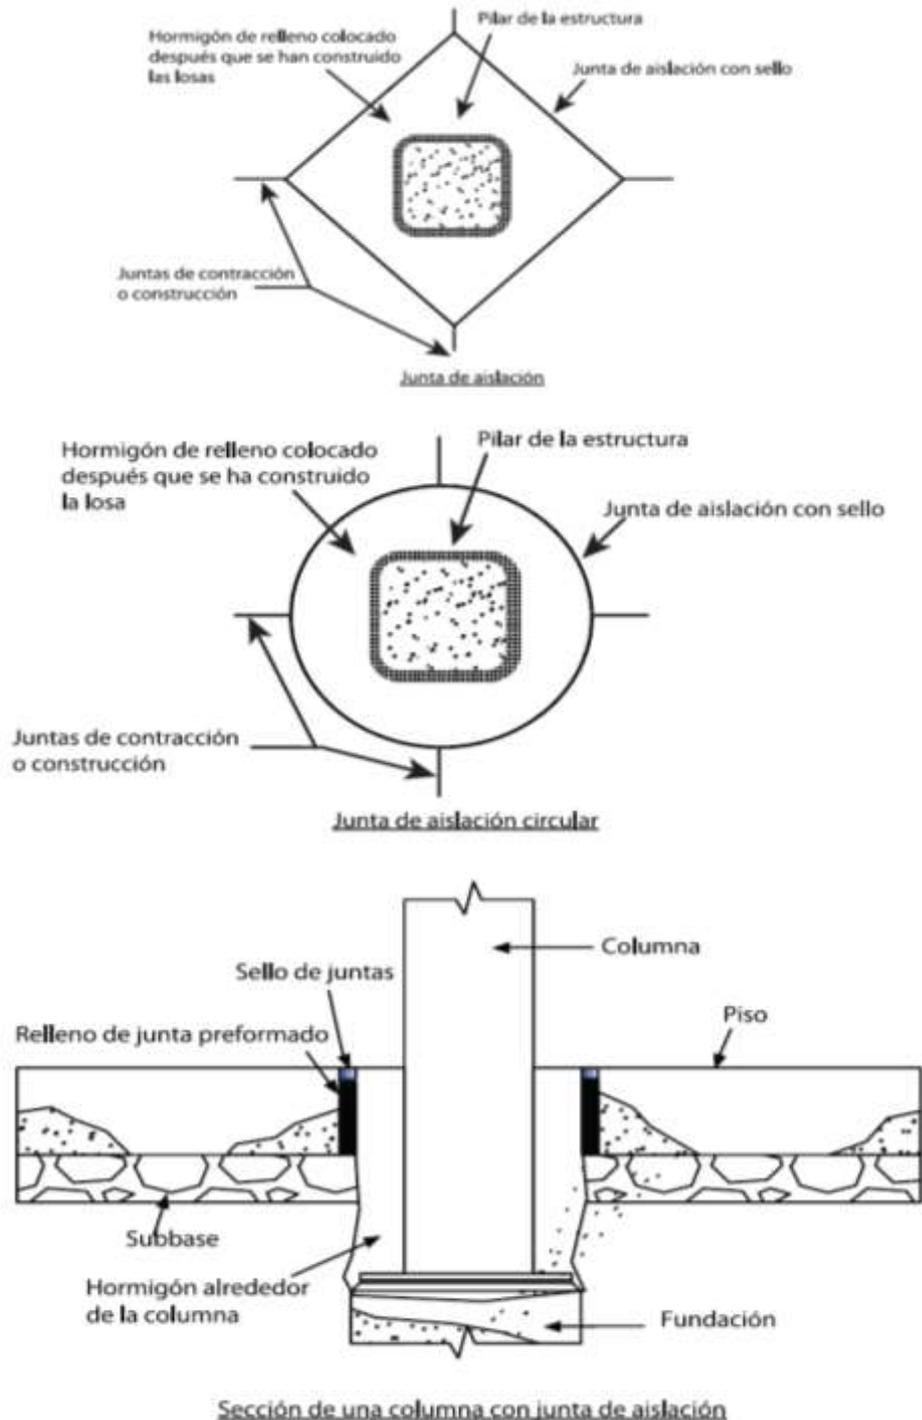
Juntas de aislamiento en muros y pilares (ACI 360R-10)
